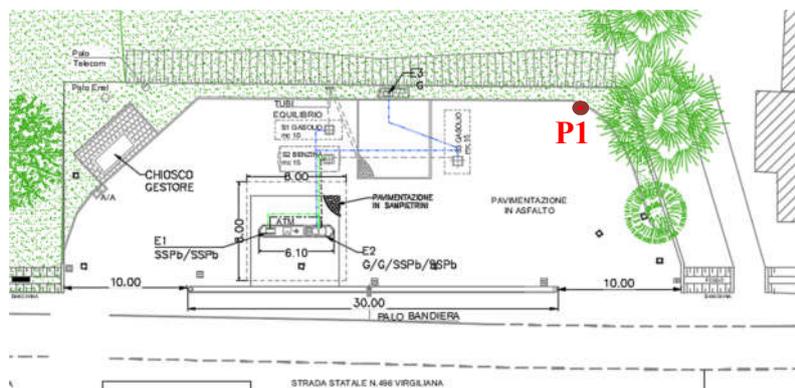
collocazione della strumentazione di misura su planimetria stato di fatto
